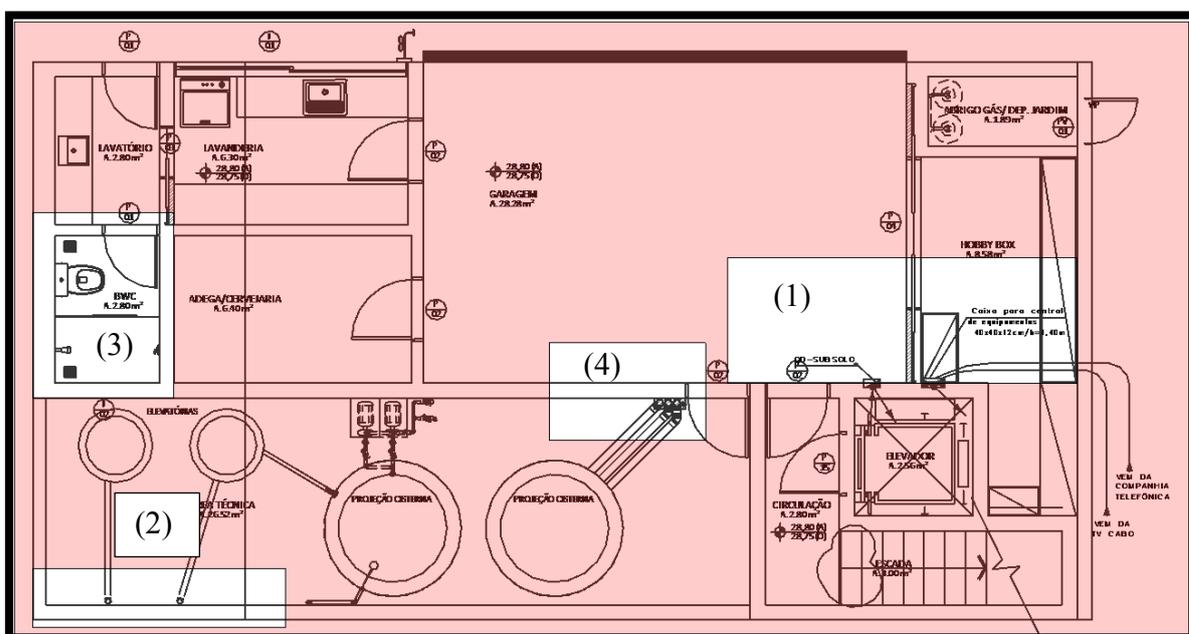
Planta baixa do pavimento subsolo com identificação das incompatibilidades
